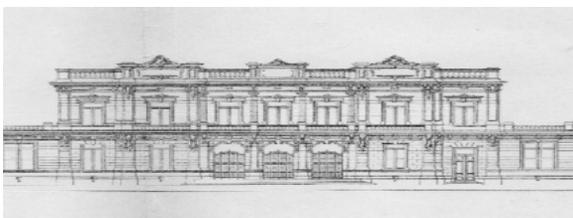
Detalle de la fachada del proyecto concretado del ingeniero Massini para la Escuela Normal Nacional.
